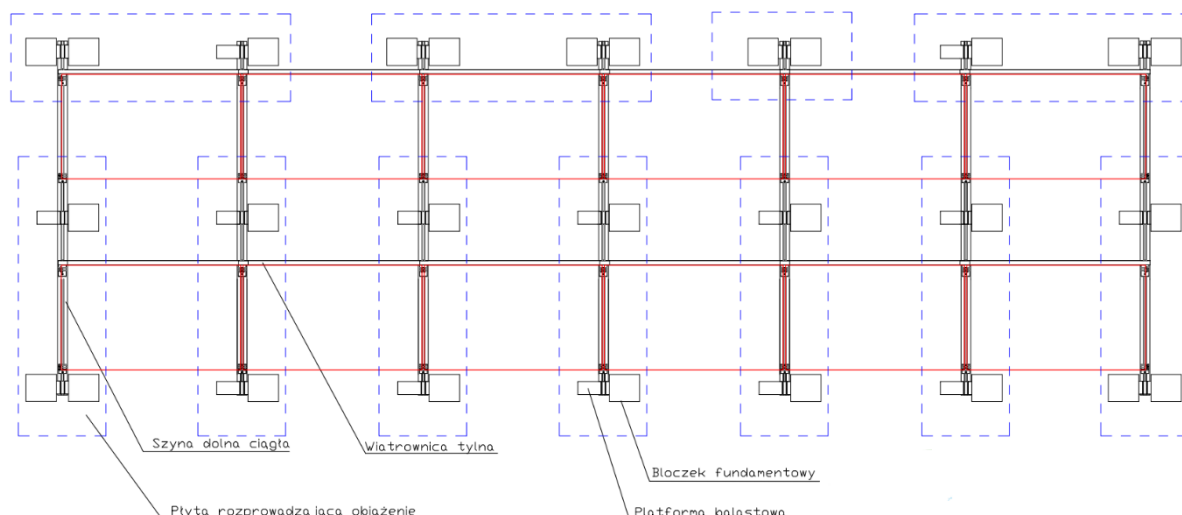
Widok schematu rozkładu przykładowej konstrukcji balastowej planowanej instalacji fotowoltaicznej.
